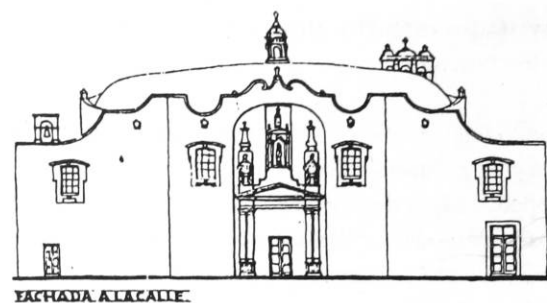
Fachada de la iglesia de Santa Brígida. Fuente: Justino Fernández. *Santa Brígida de México*.
